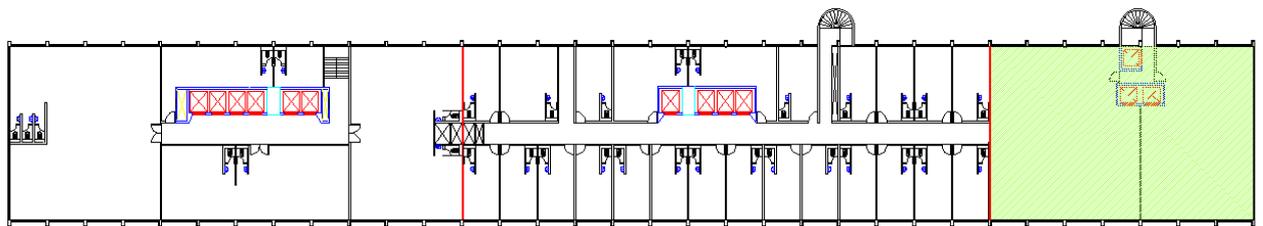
Planta esquemática do pavimento-tipo do 14º ao 23º andar. À esquerda o Horsa 2 com escritórios maiores, no meio o Horsa 1 com pequenos conjuntos e à direita 2 apartamentos por andar
